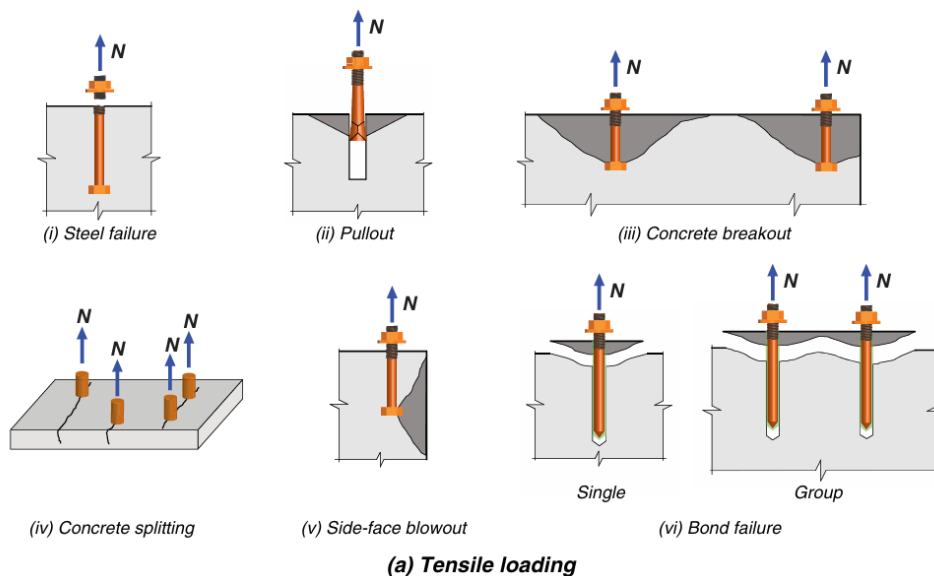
Principales modos de falla del acero a tracción. Tomado de *Building Code Requirements for Structural Concrete (ACI 318-19)*, por American Concrete Institute, 2019. Copyright 2019 por American Concrete Institute.
